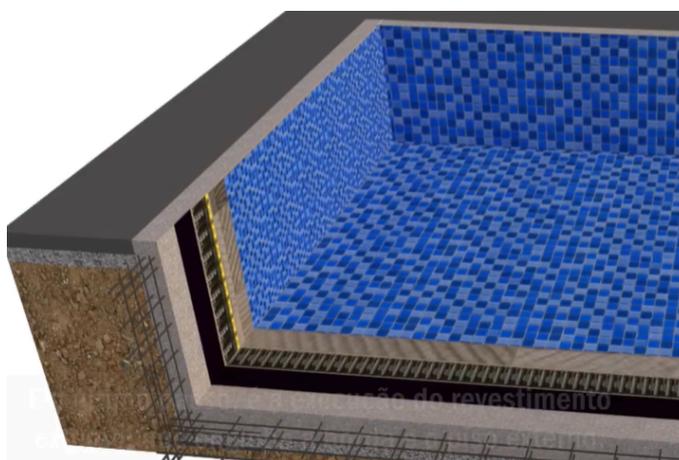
Corte esquemático de piscina de concreto até a fase de impermeabilização
